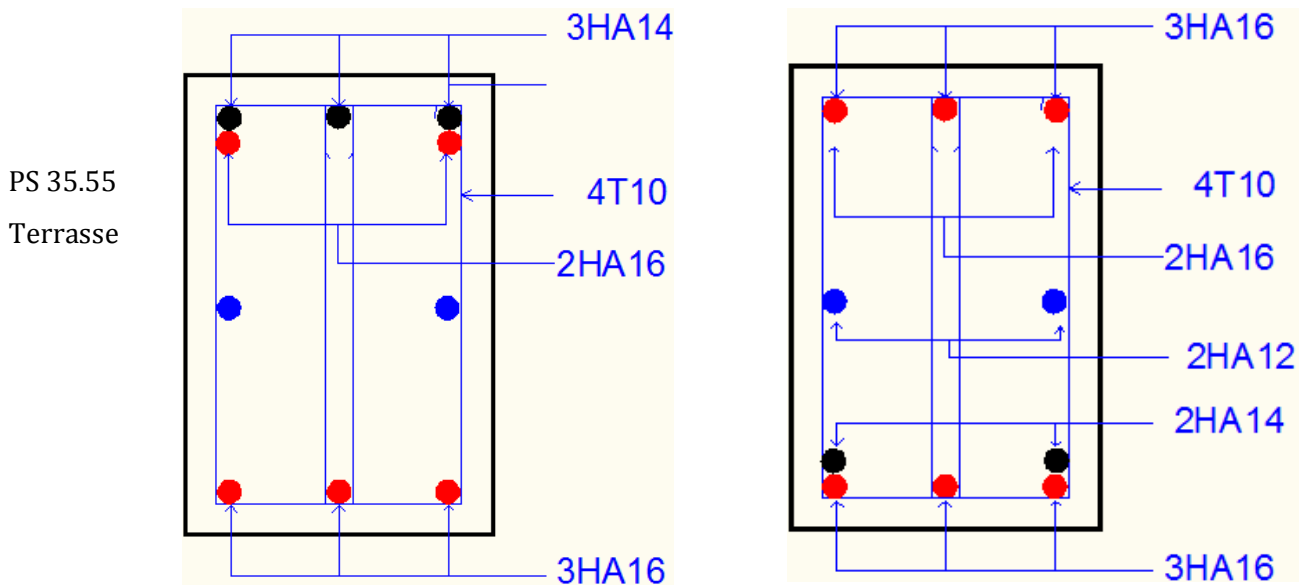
Section de ferrailage des poutres secondaire terrasse.
